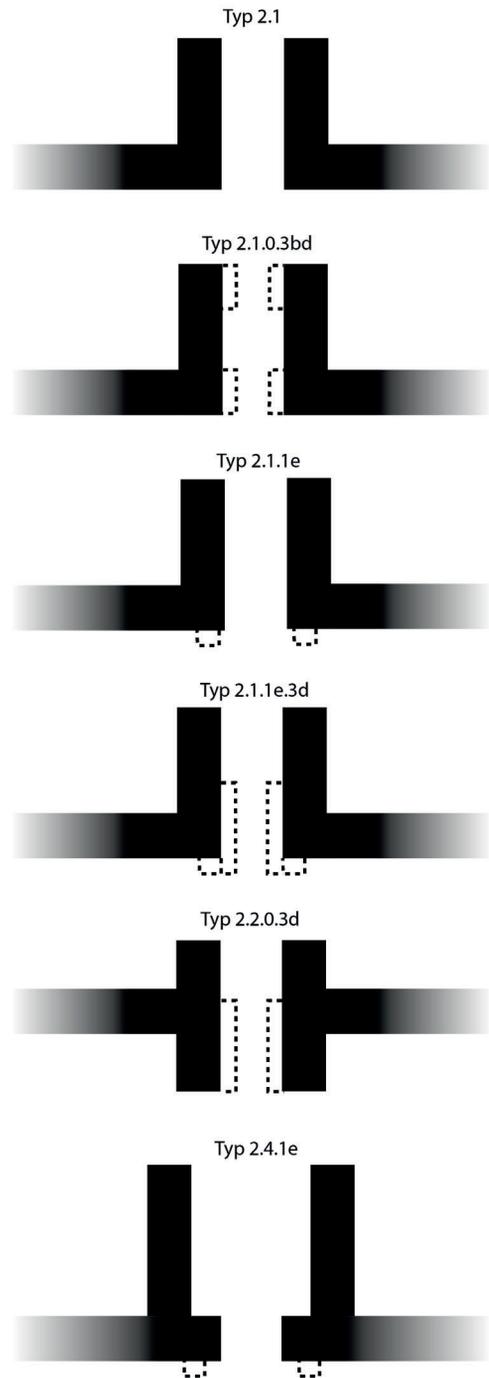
Auswahl möglicher Torgrundrisse des Typs 2
